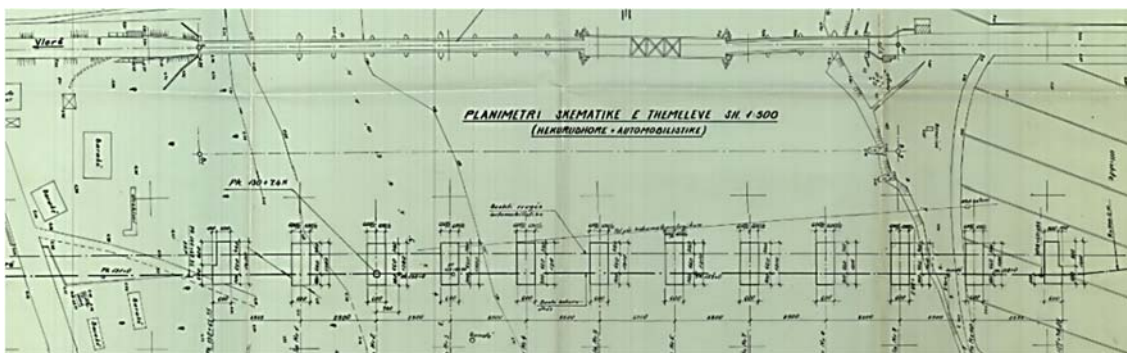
Planimetria skematike e themeleve ([6])
